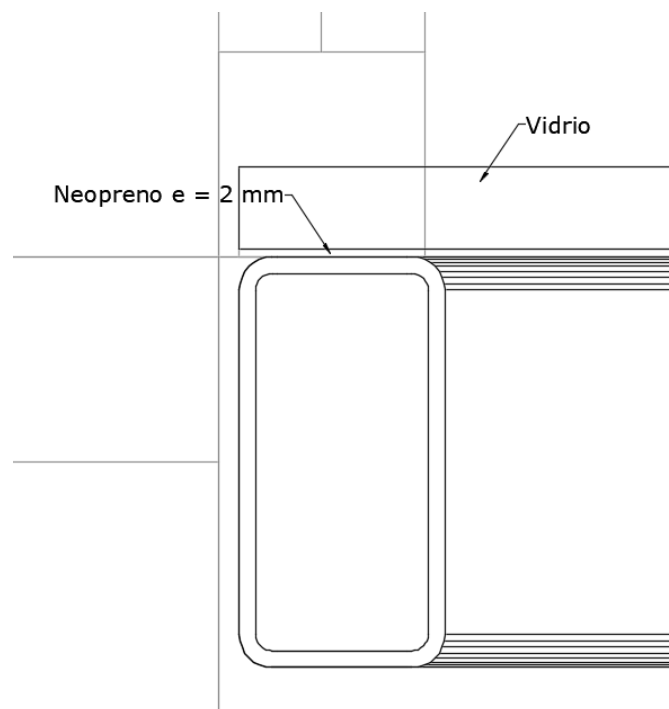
Detalle de apoyo de vidrio sobre perfilería
